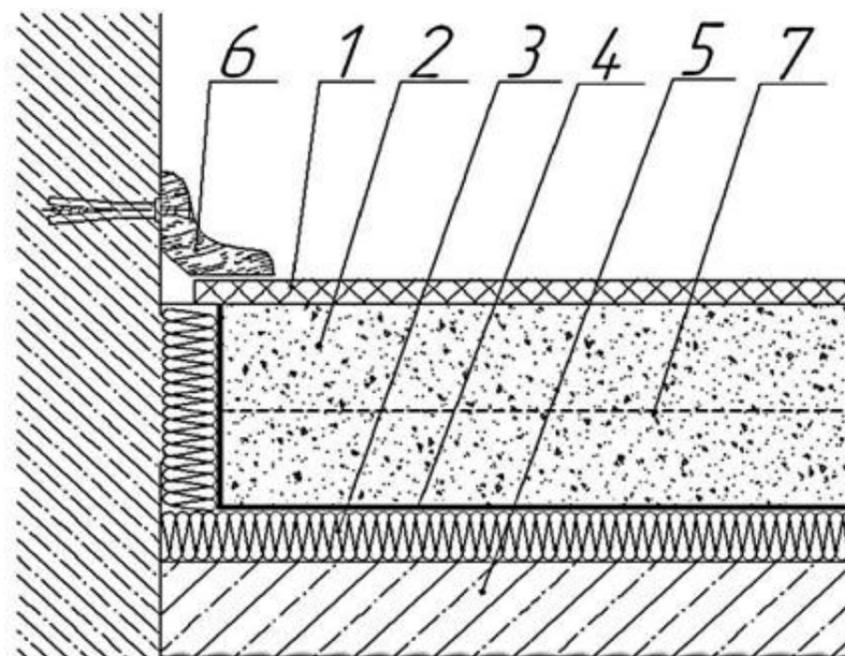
Типовой узел конструкции «плавающего» пола:
